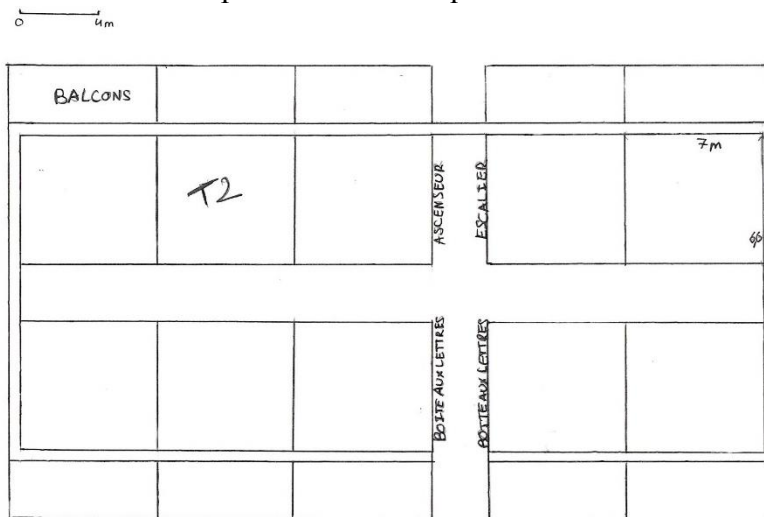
Plan d'un étage d'un bâtiment, source: Clara Sarnelli
